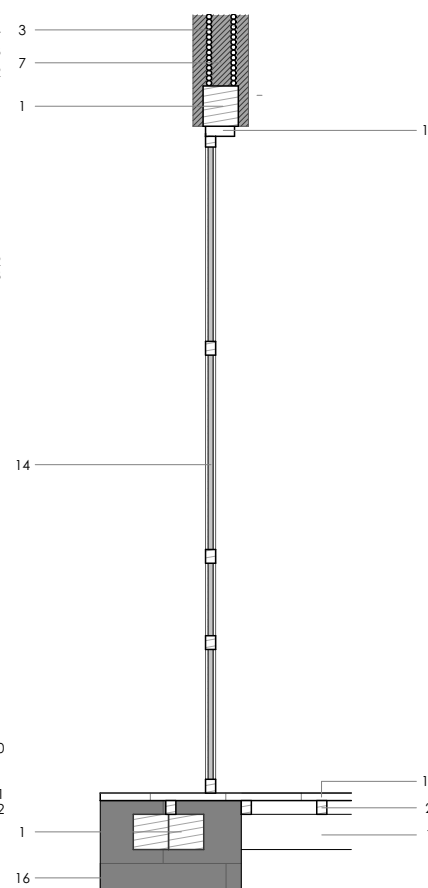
Detalle Constructivo 03. Esc. 1:50
